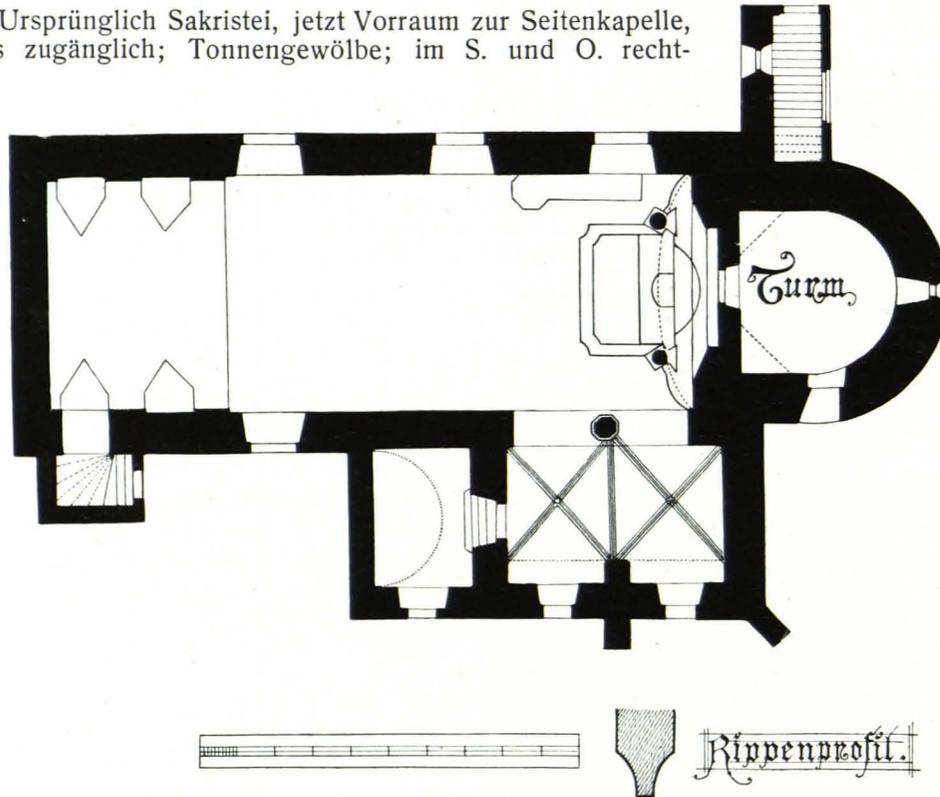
Groß-Reinprechts, Pfarrkirche, Grundriß 1 : 200 (S. 199)
